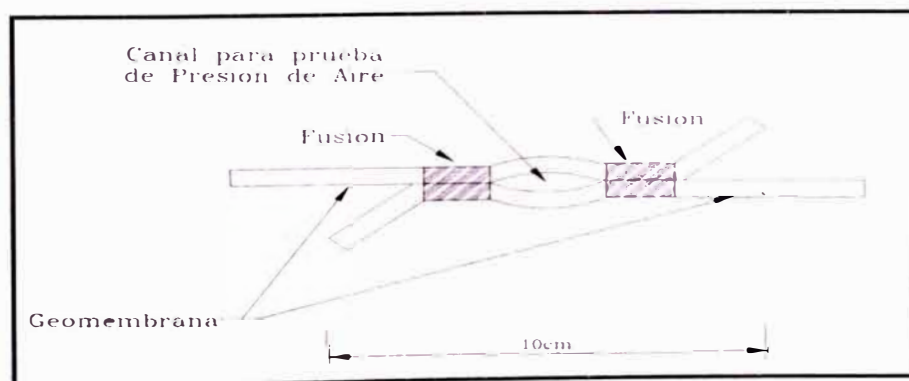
Detalle típico de soldadura por fusión.
